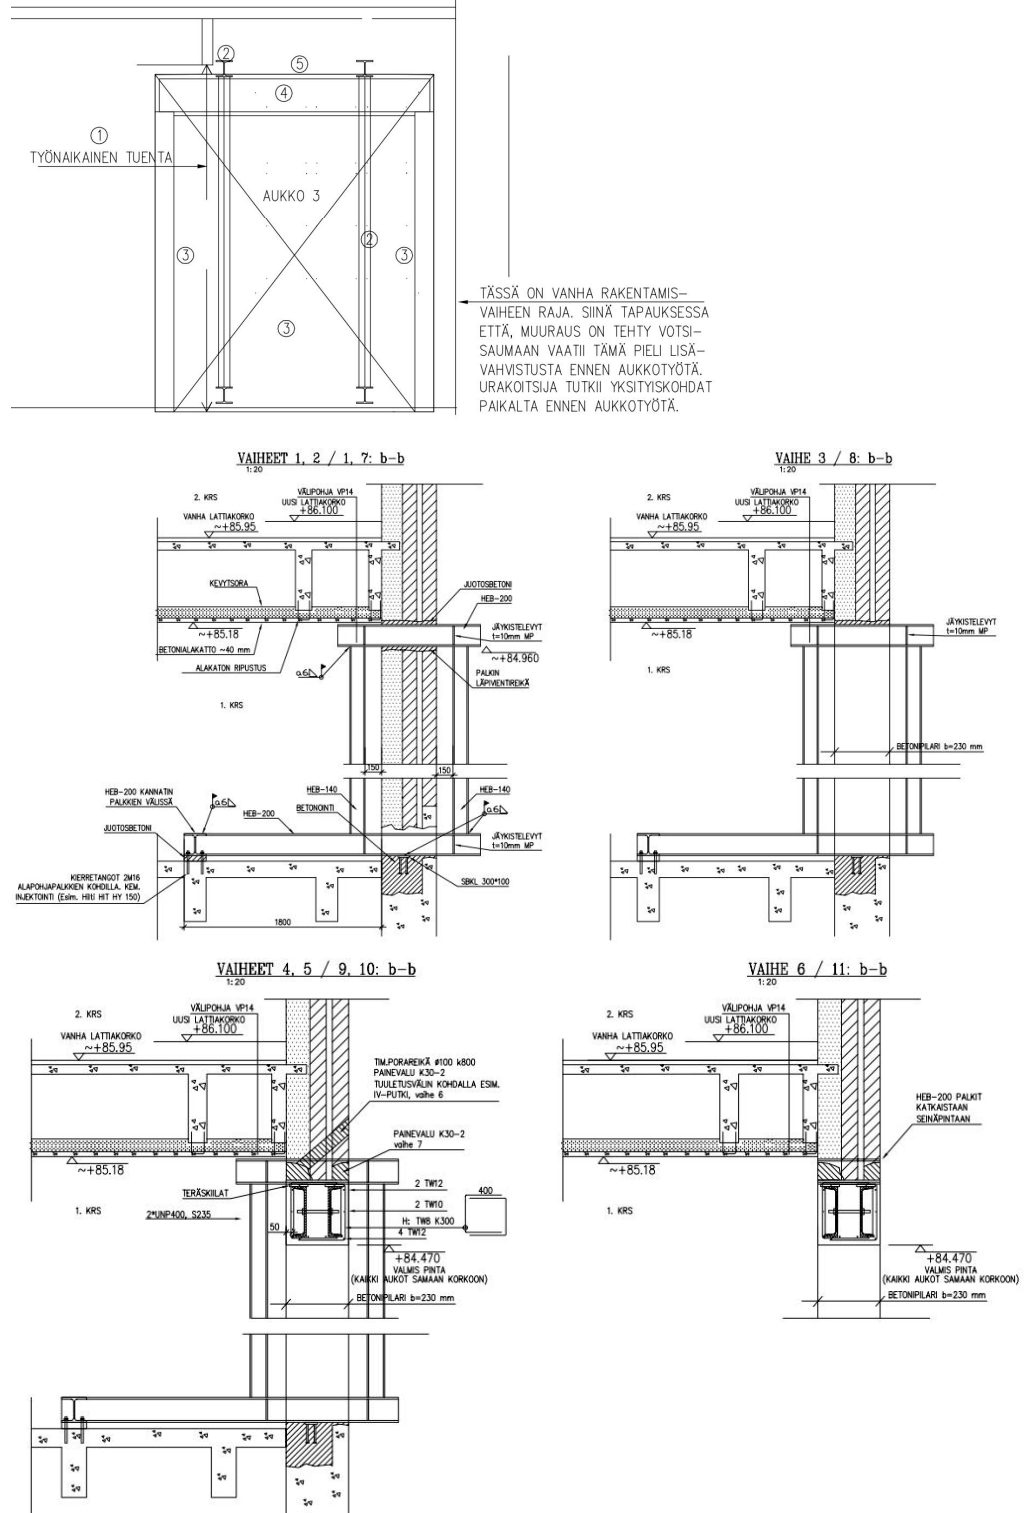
Tiiliseinän aukon tuenta UNP-palkeilla ja teräsbetonipilareilla (Vahnen Oy).
